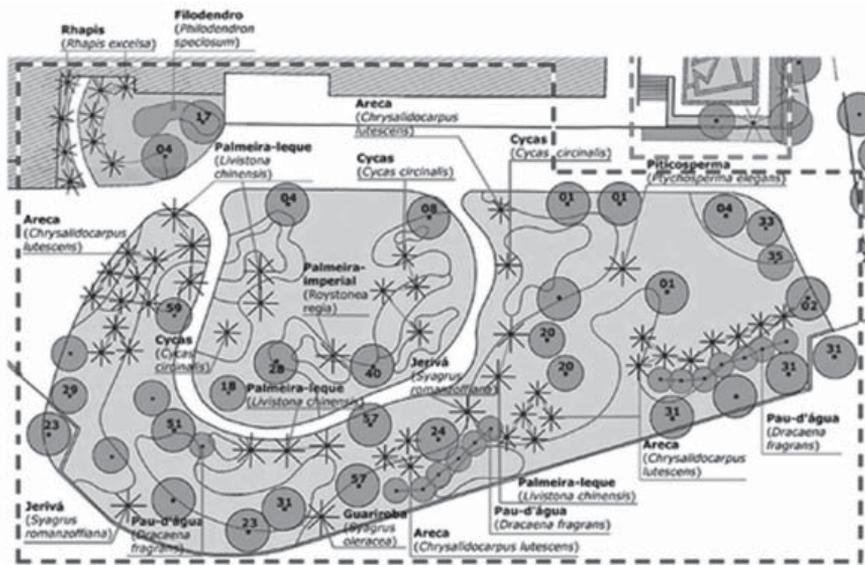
Planta de restauração do jardim frontal – Desenho indicativo das árvores e palmeiras.
